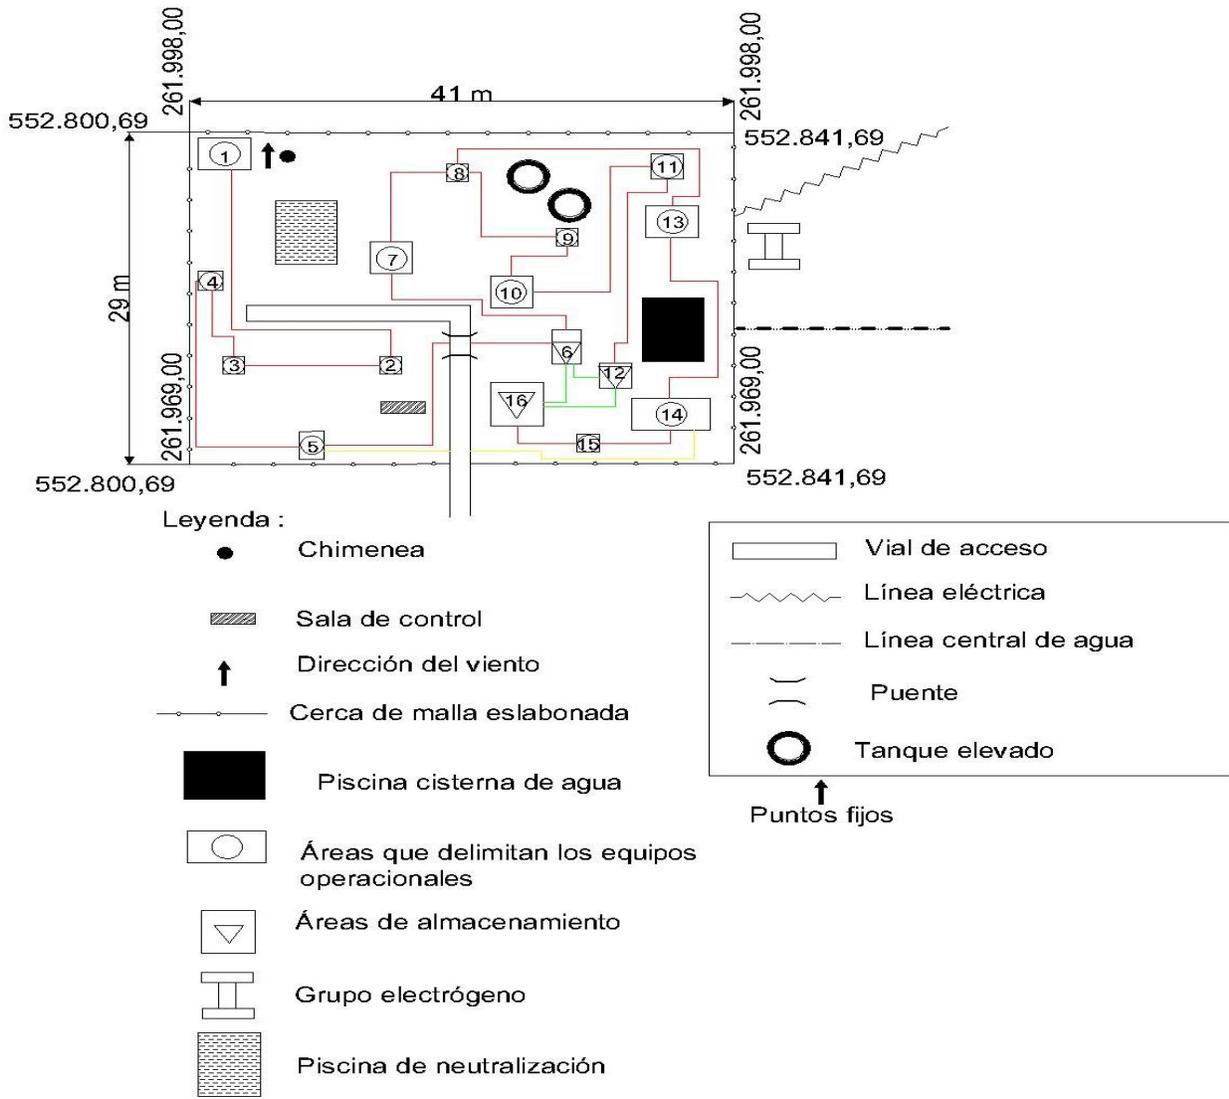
Alternativa 1 del plan general. Fuente: Elaboración Propia.
